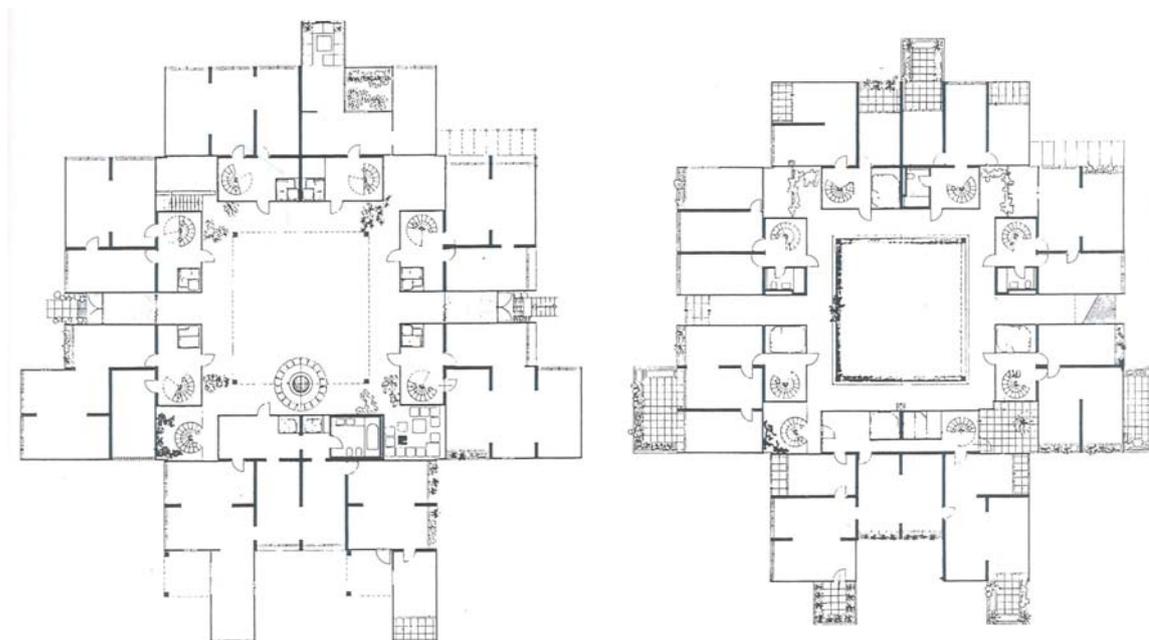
Grundriss Erdgeschoss (l)
